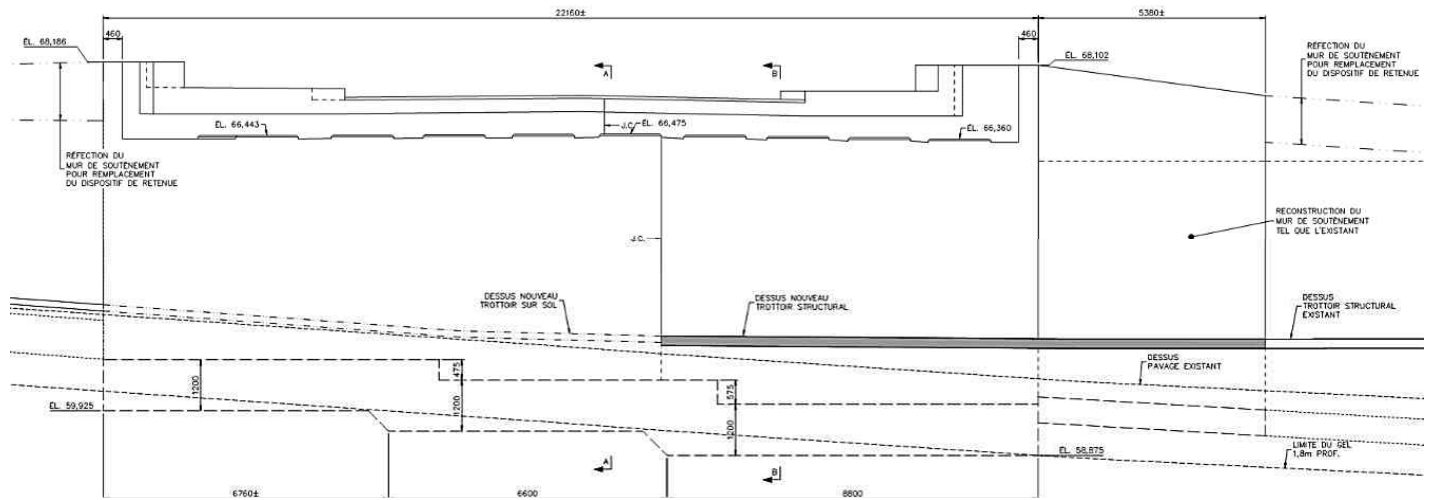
Pont d'étagement routier – Culée proposée axe 3 – Vue en élévation
